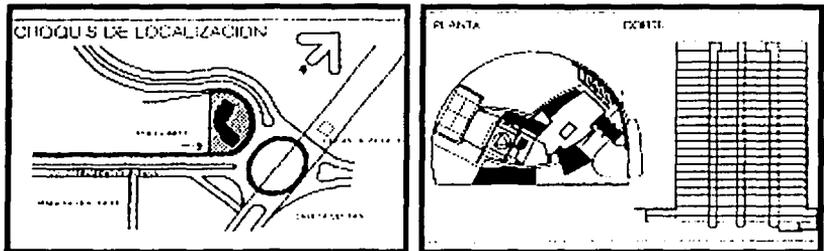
Croquis de localización, planta y corte esquemático del ejemplo aplicativo: "El Mirador"
